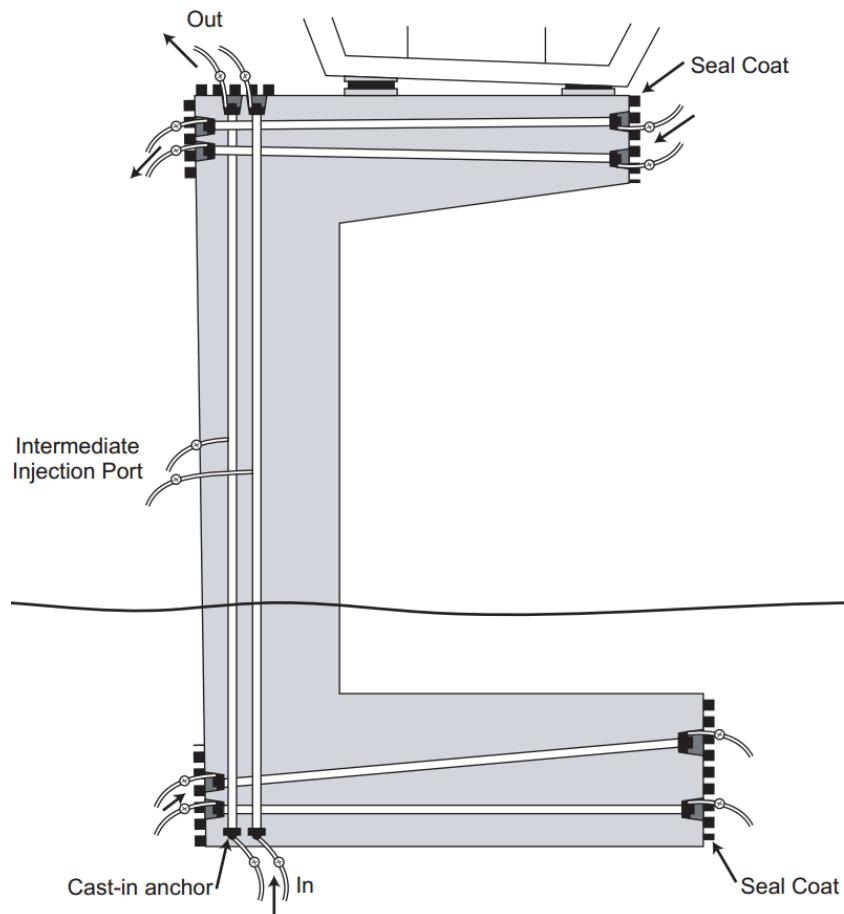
Detalles de grouting y protección del anclaje para tendones verticales y laterales en pilar-C.
